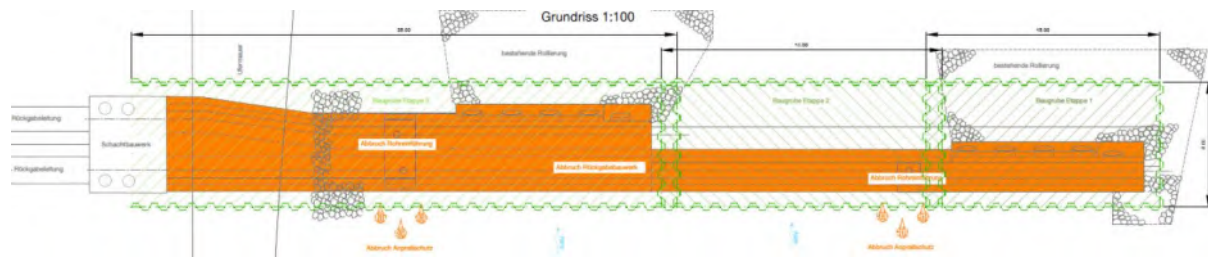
Grundriss Rückbau Auslaufbauwerk
